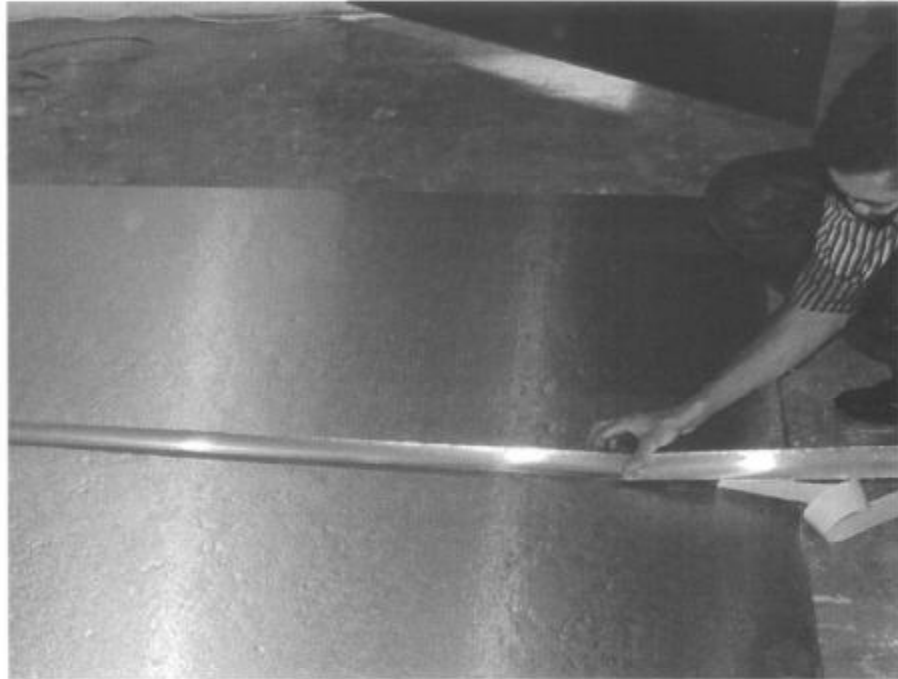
Aplicação de fita adesiva metálica na junção entre painéis.
